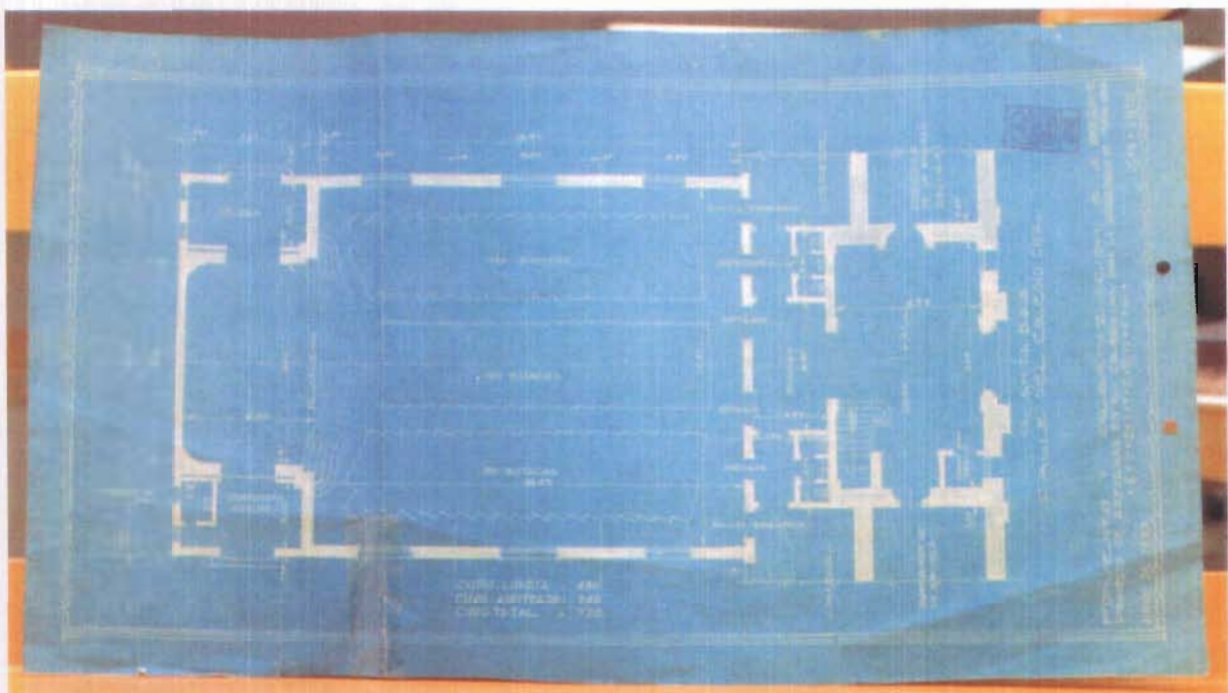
Aula Magna*. Planta baja. Heliográfica de proyecto arquitectónico.
